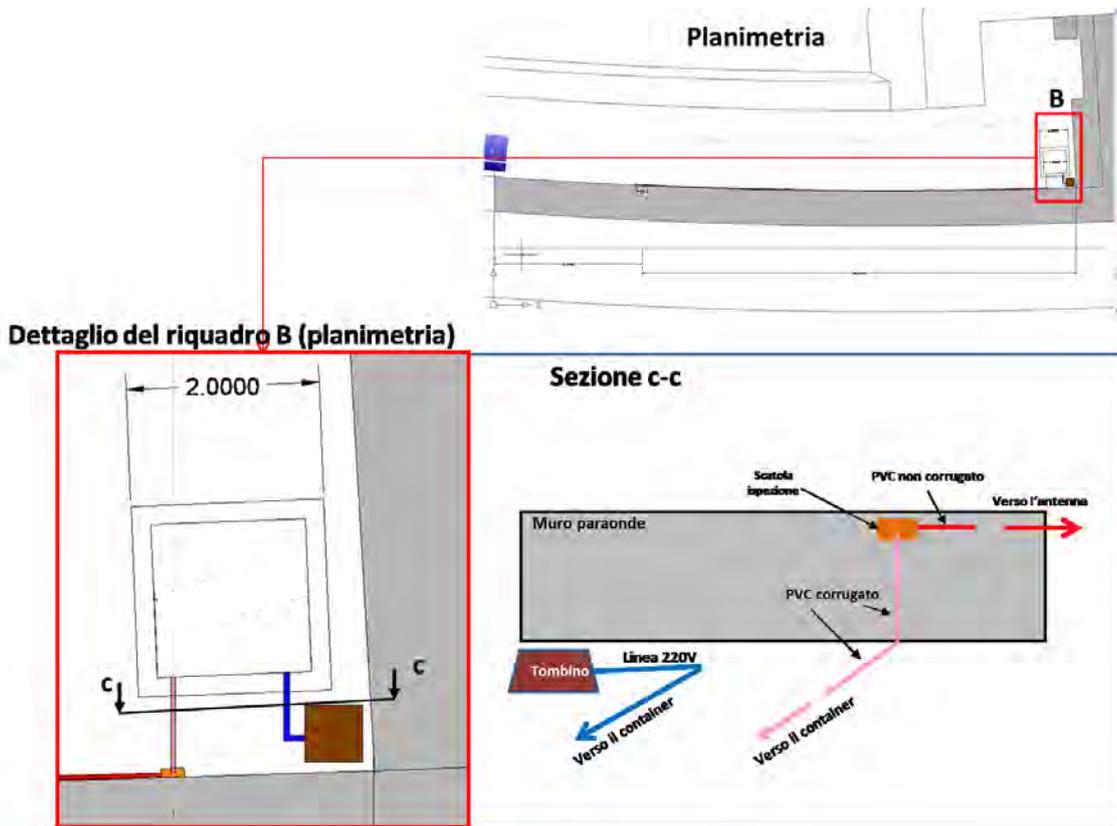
Dettaglio possibile collegamento dati ed elettrico al sito di installazione dello shelter.
